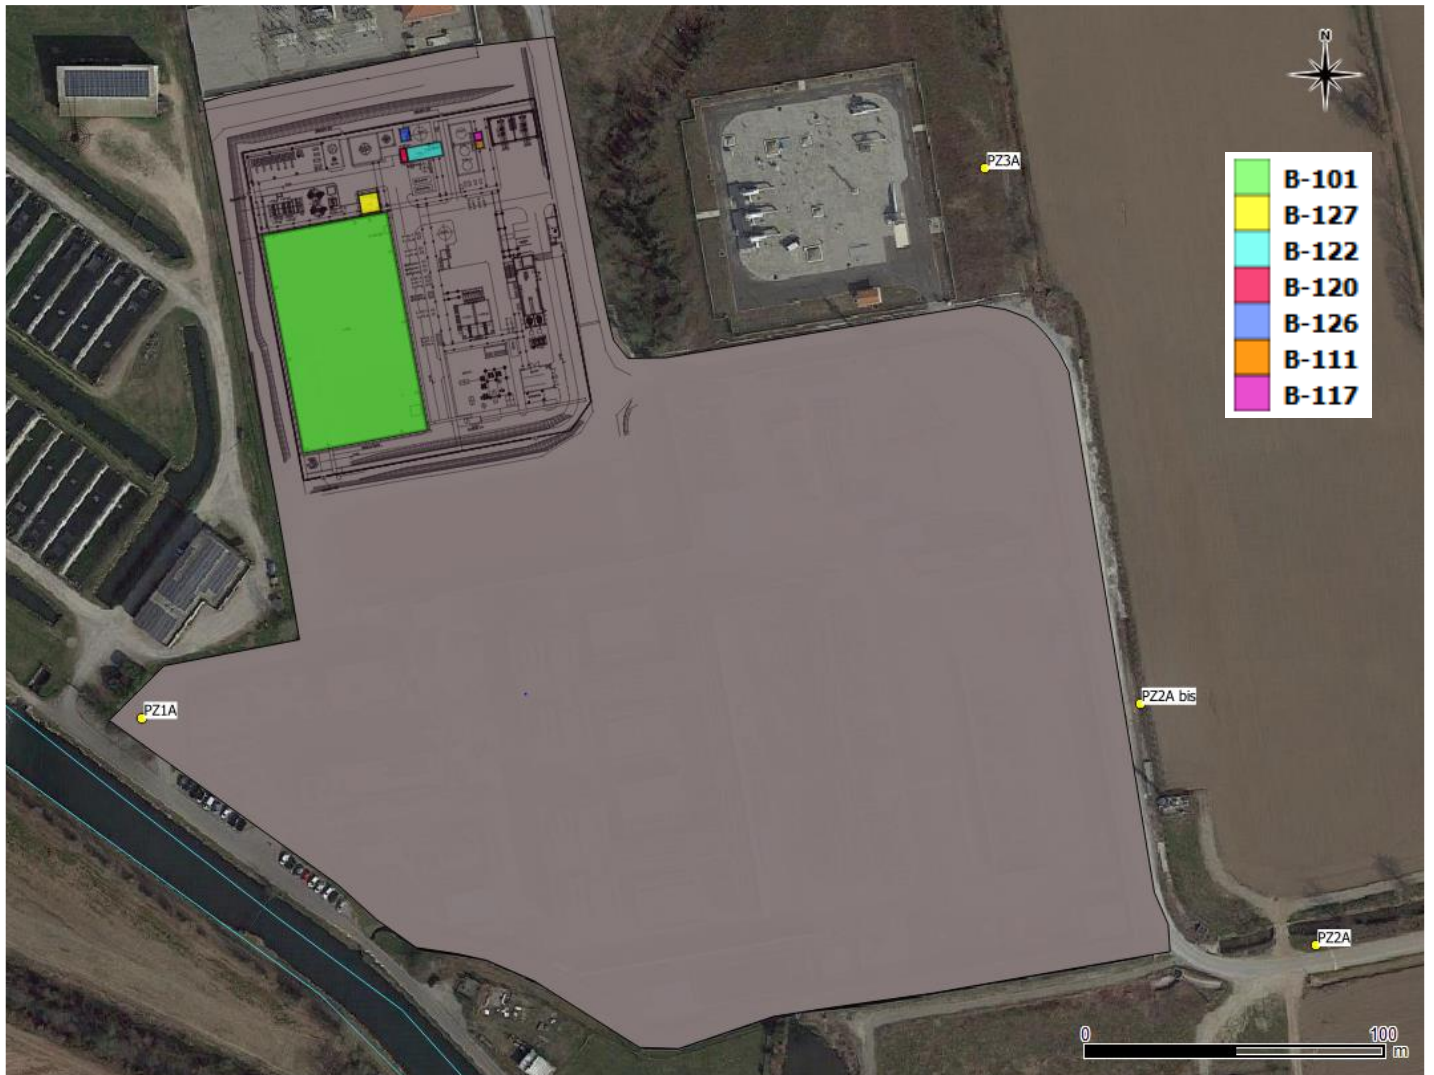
Layout opere interferenti con la falda e attuale rete piezometrica
